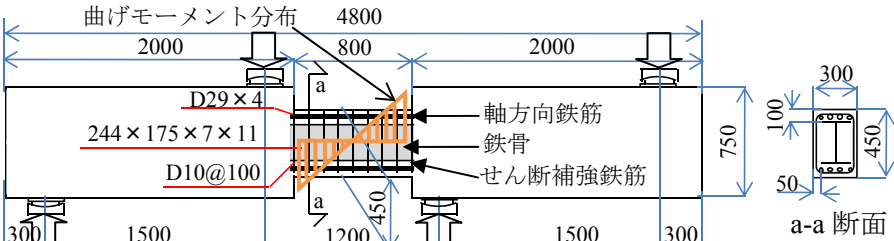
試験体諸元の例 (No. 2, 単位 : mm)
